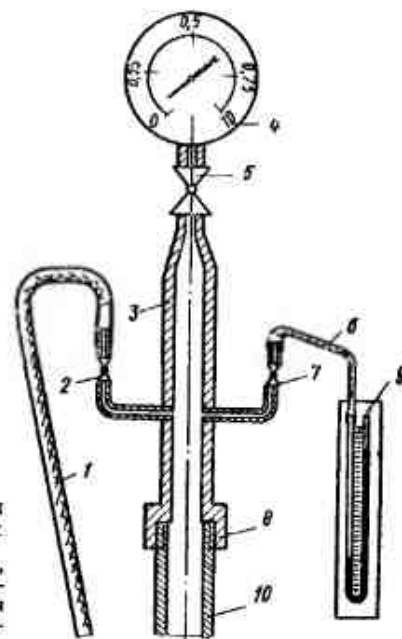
Приспособление для продувки и проверки давления газа в газопроводах:
